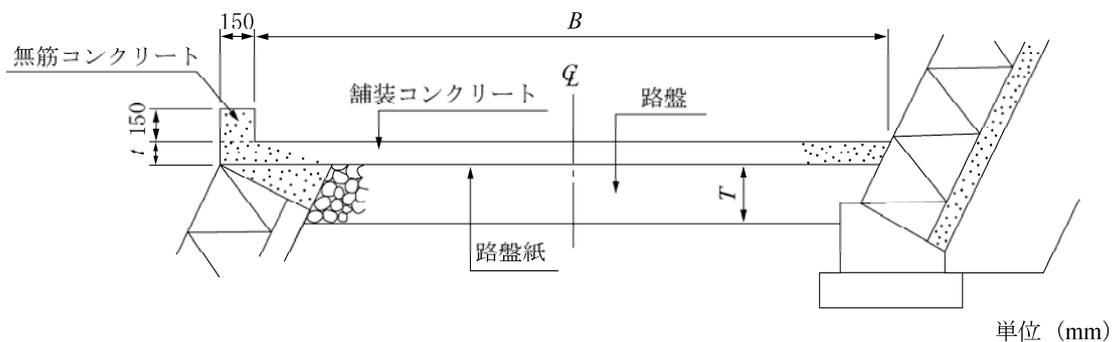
水兼農道標準構造図（コンクリートブロック積の場合）
